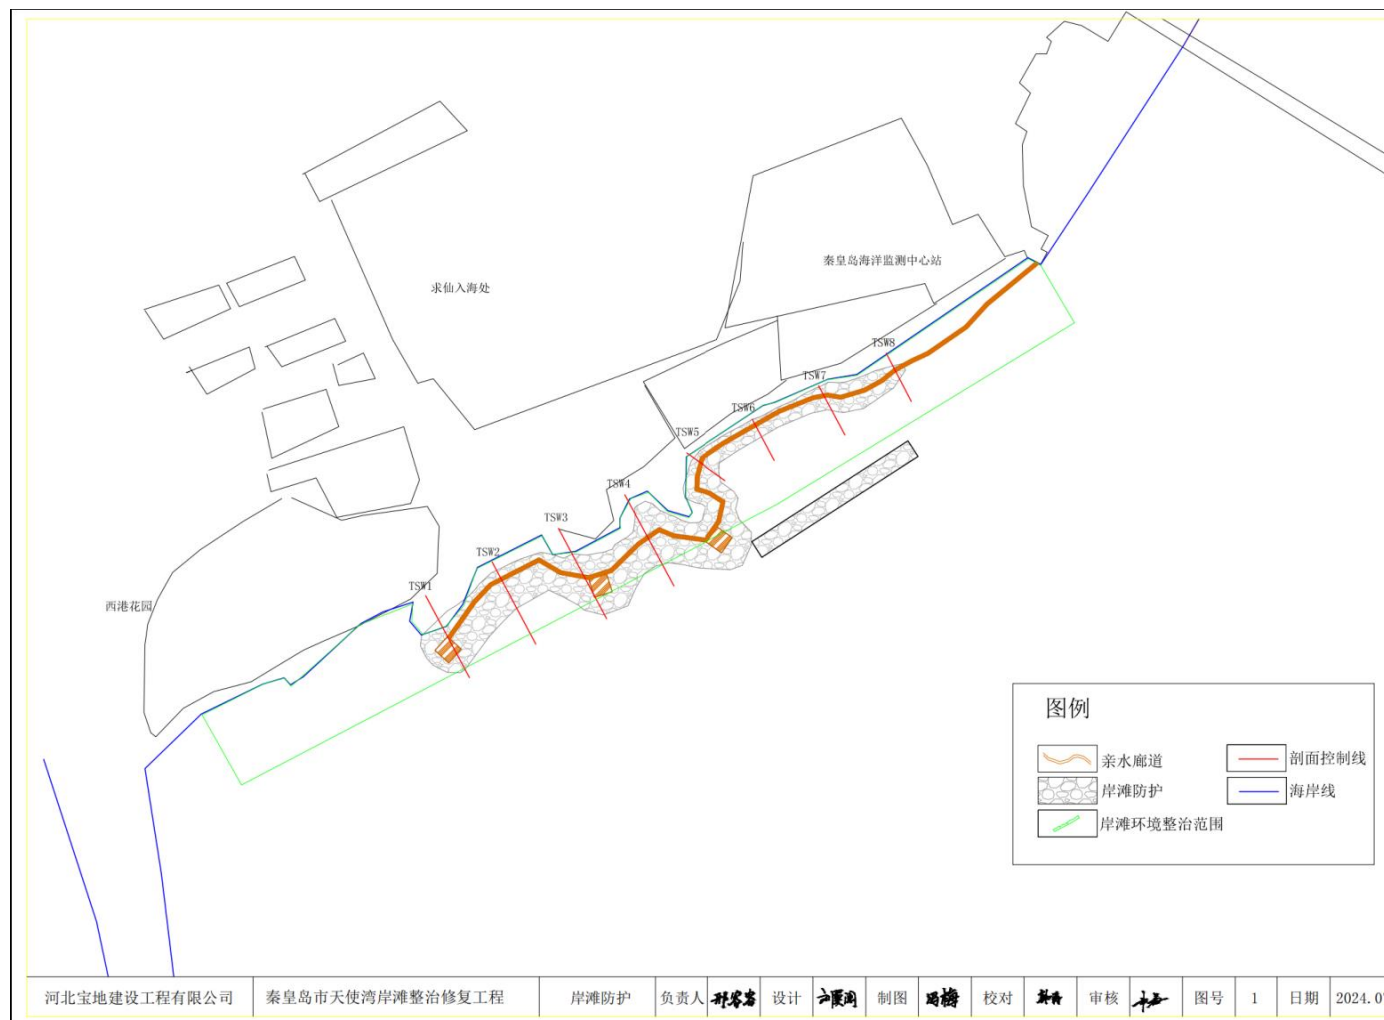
本项目总平面布置图 (坐标系, 高程)
